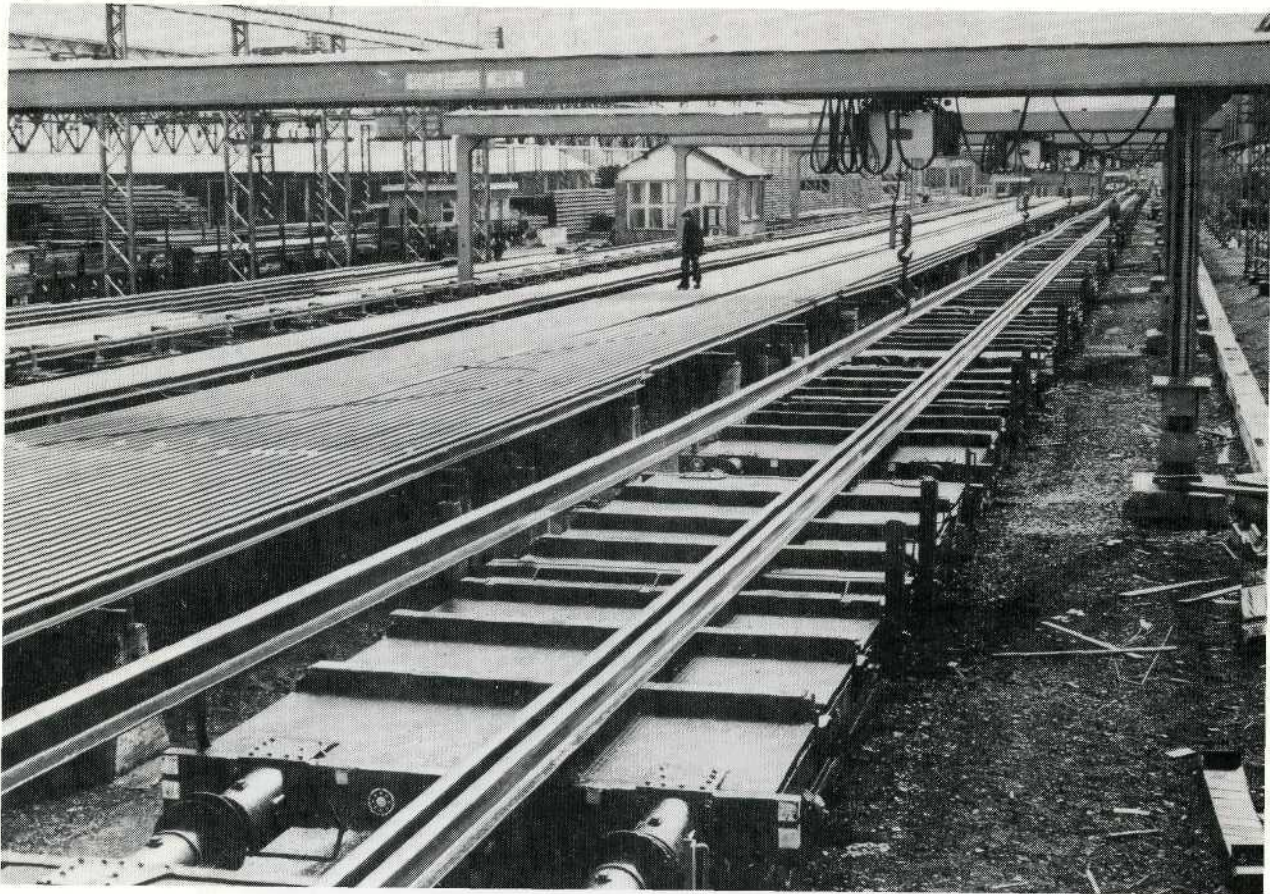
Transfert latéral d'une longue barre soudée.
